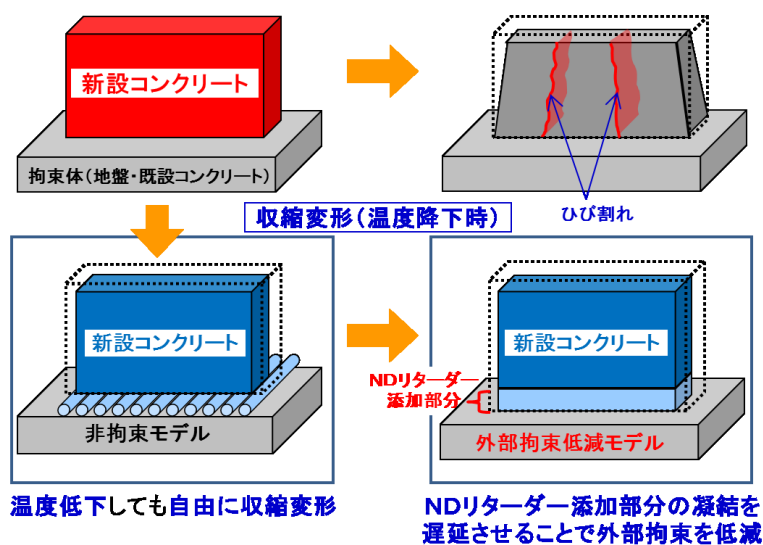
NDリターダー工法のひび割れ抑制メカニズム
